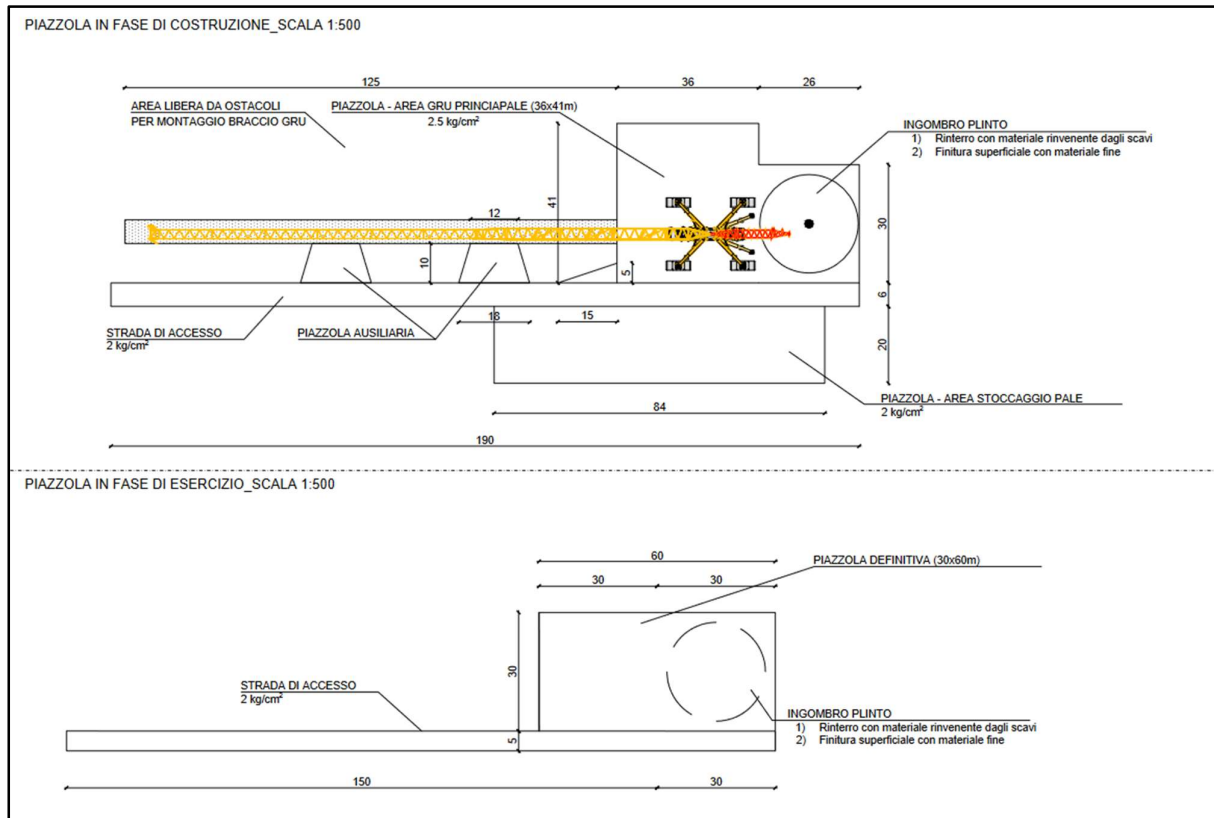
Planimetria piazzola tipo per la fase di installazione e fase di esercizio e manutenzione
